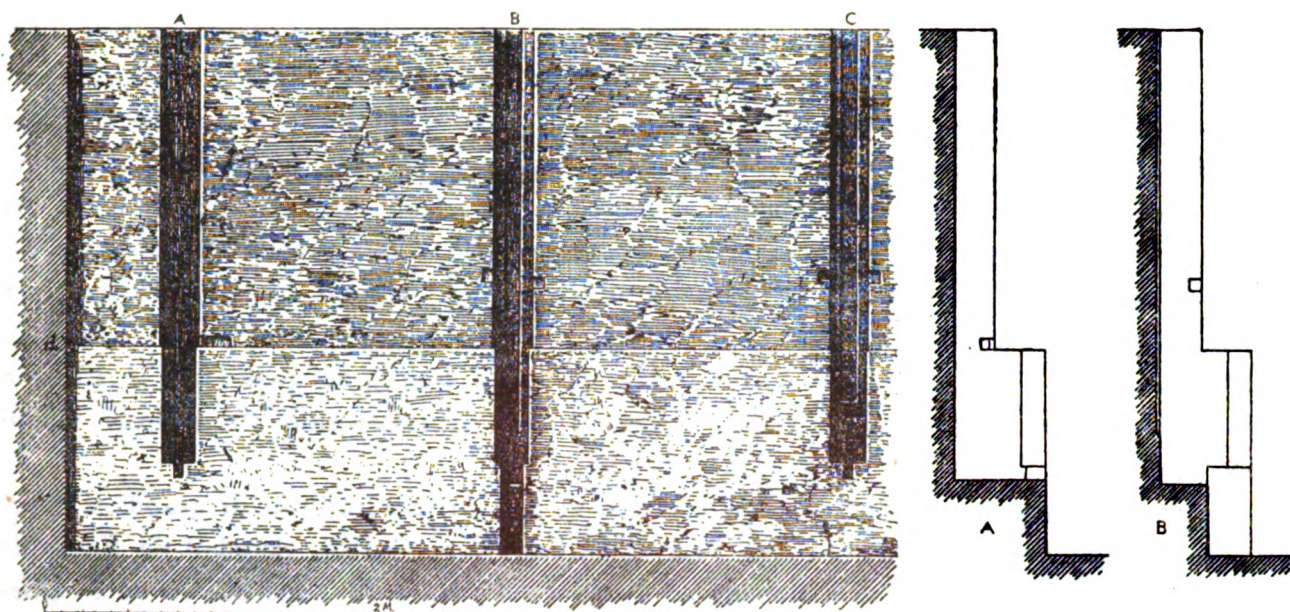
PARTICOLARE DELLA PARETE: PROSPETTO DELLE "INCASSATURE", E SEZIONI VERTICALI DELLE PRIME DUE.
